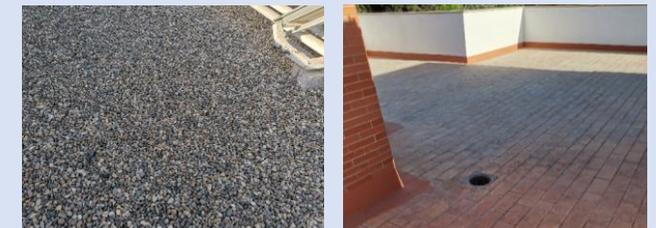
Foto de la cubierta plana no transitable de grava. Fuente: autoría propia.
